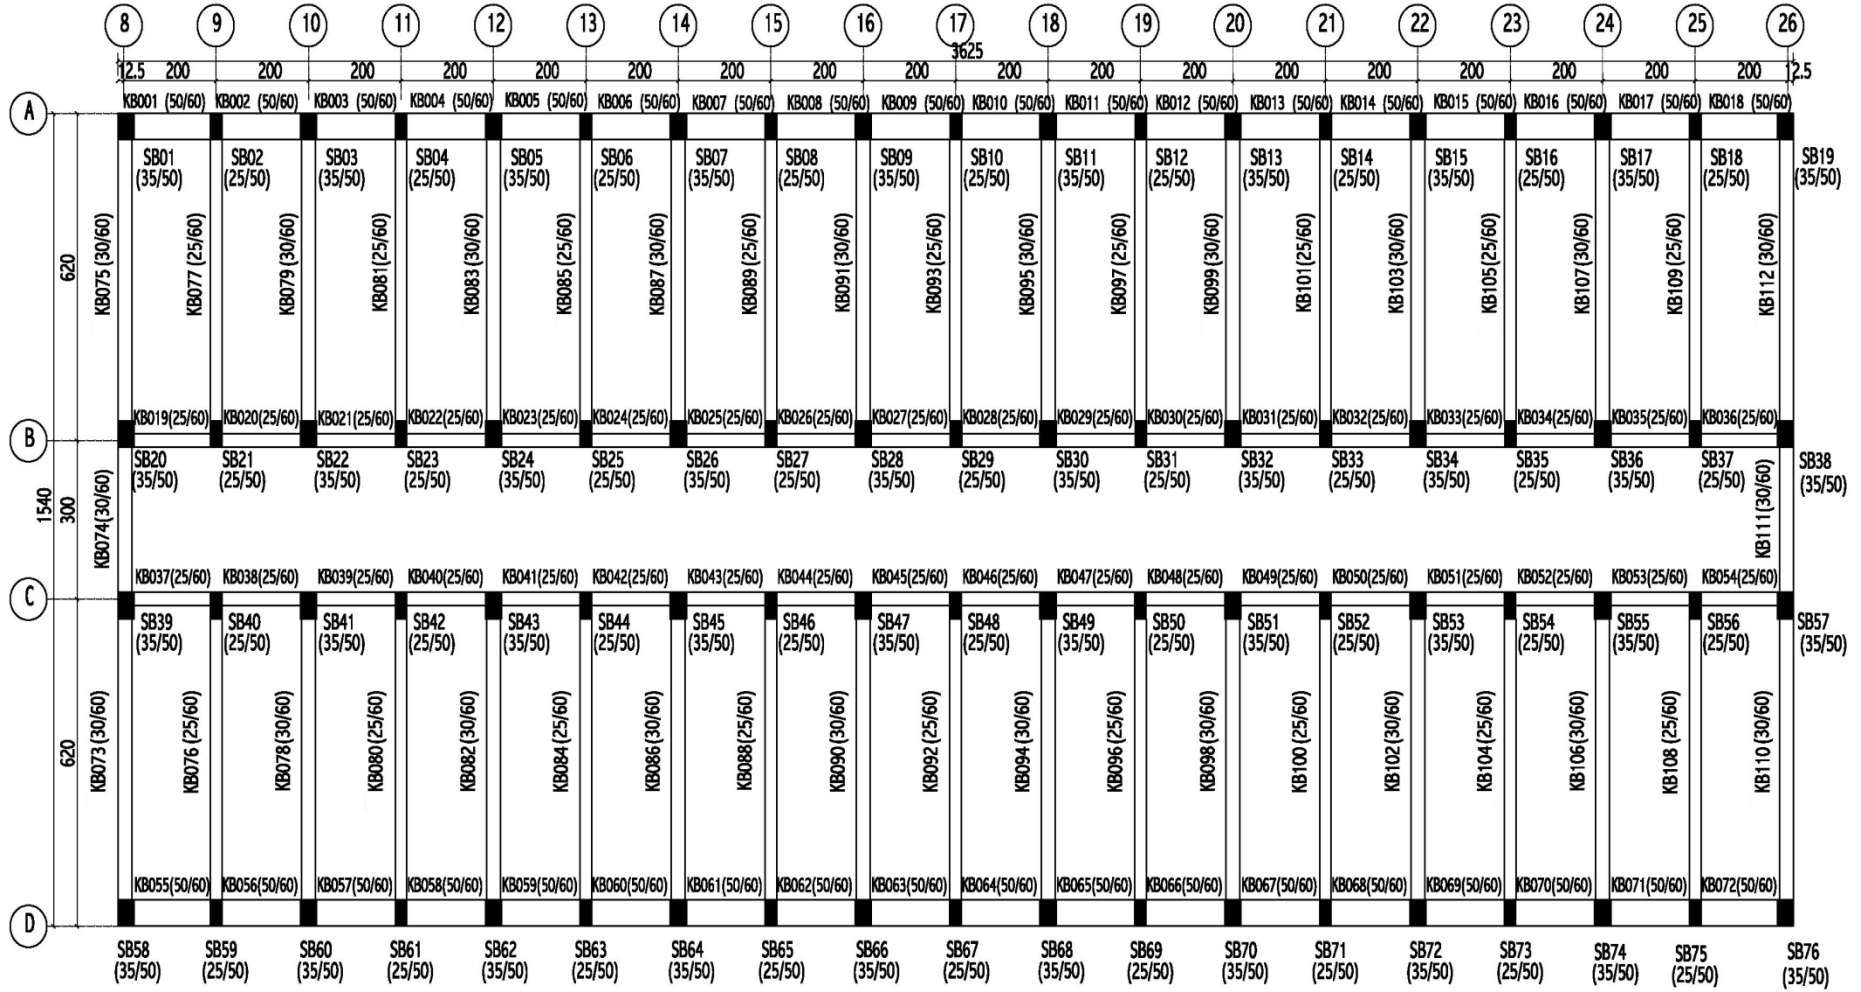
İlk Ortaokulu-B Blok kalıp planı
